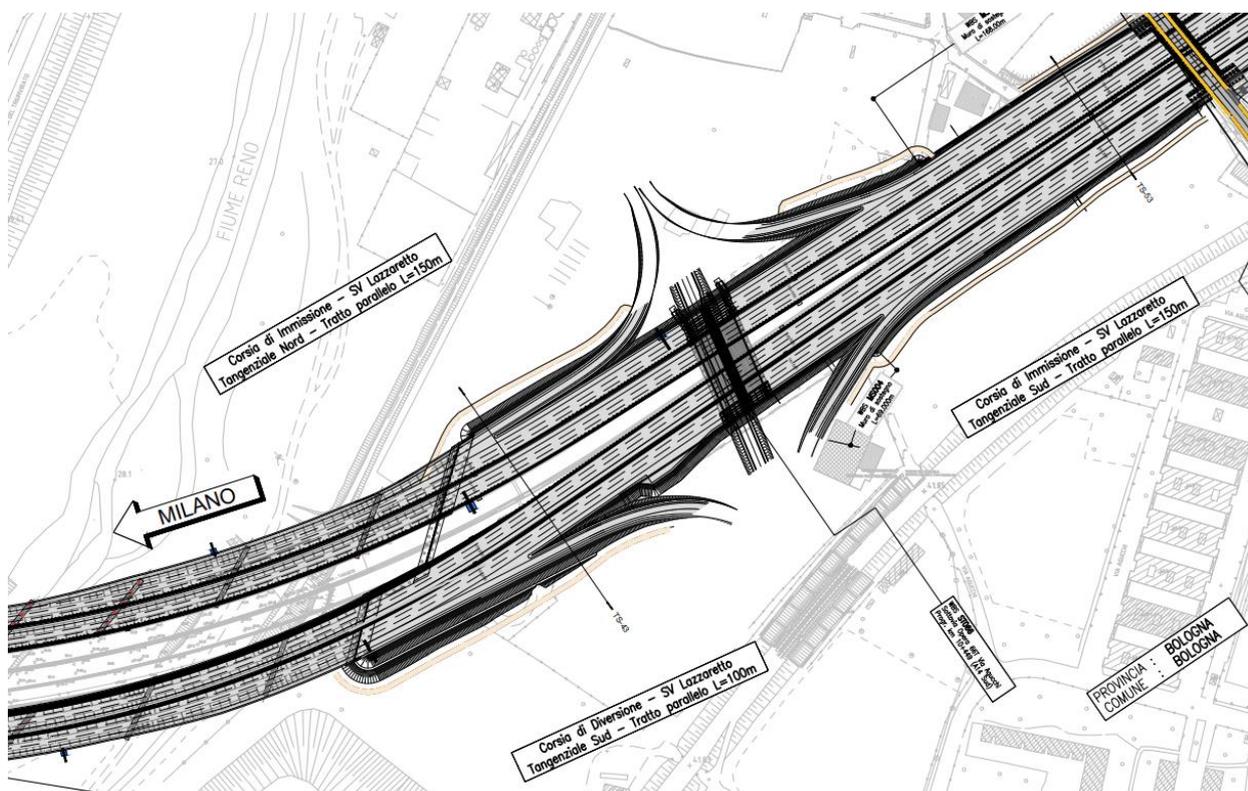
Estratto Progetto Esecutivo del sistema autostradale e tangenziale di Bologna, planimetria con dettaglio delle opere
